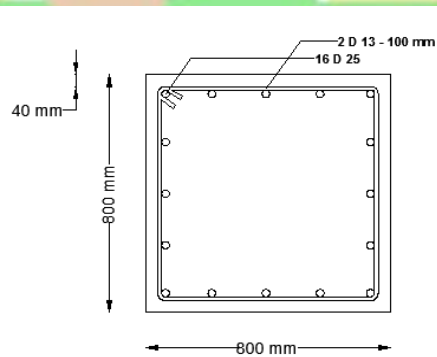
Detail Penulangan Balok Bangunan 1
